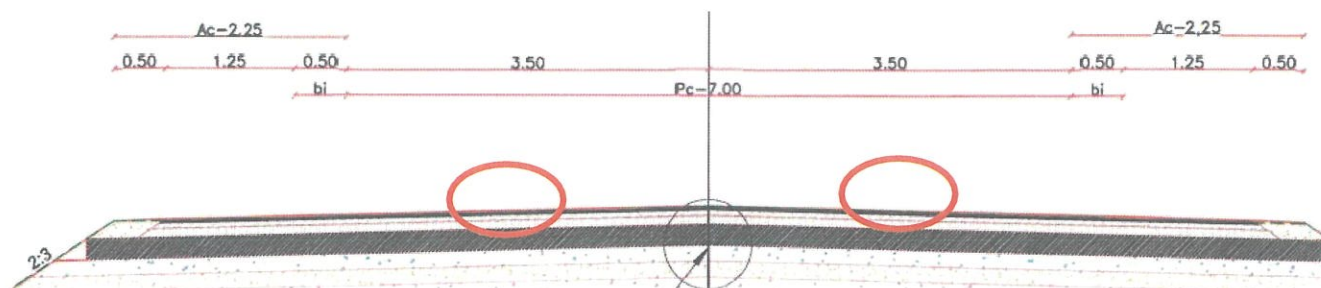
Profil transversal tip proiectat – varianta nr. 2 (fără pante transversale)
